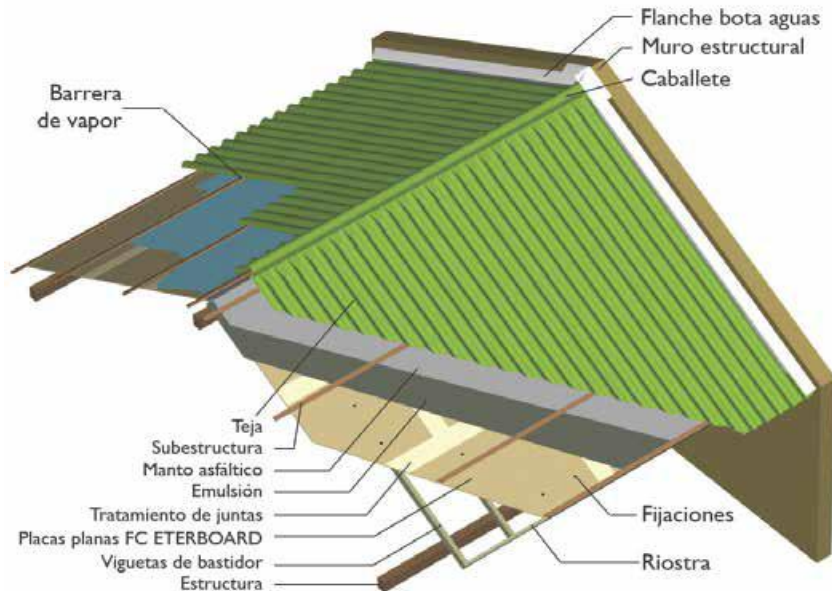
Detalle de la estructura de la cubierta con placas de fibrocemento
